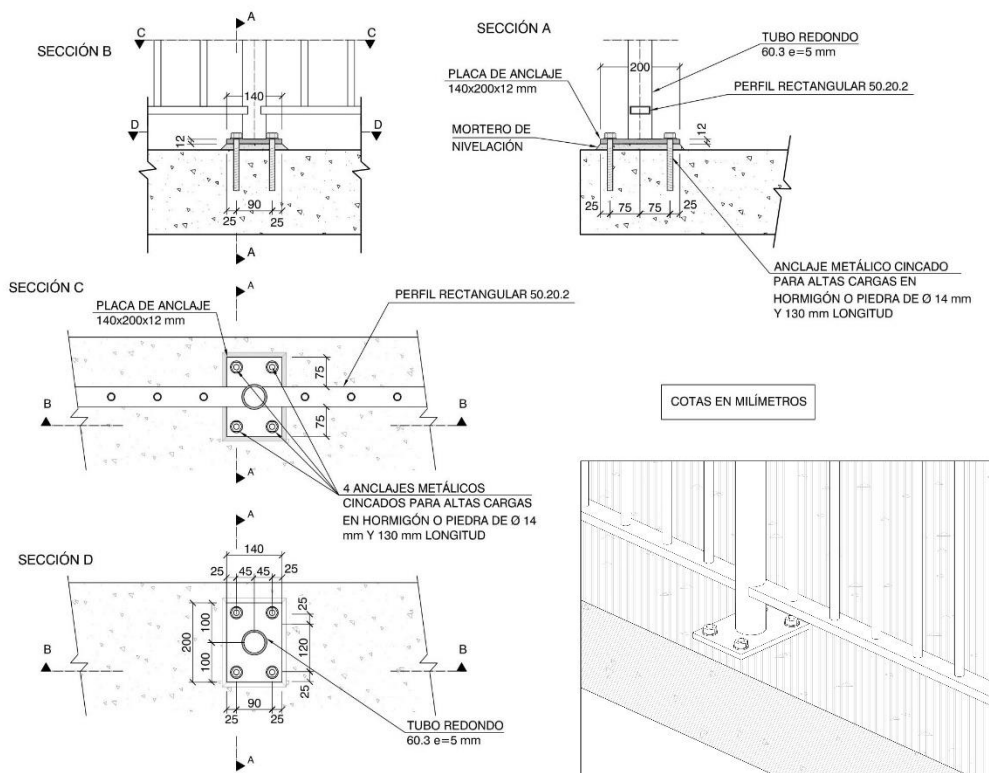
Detalles y vista del anclaje de la barandilla. Fuente: Elaboración propia.
